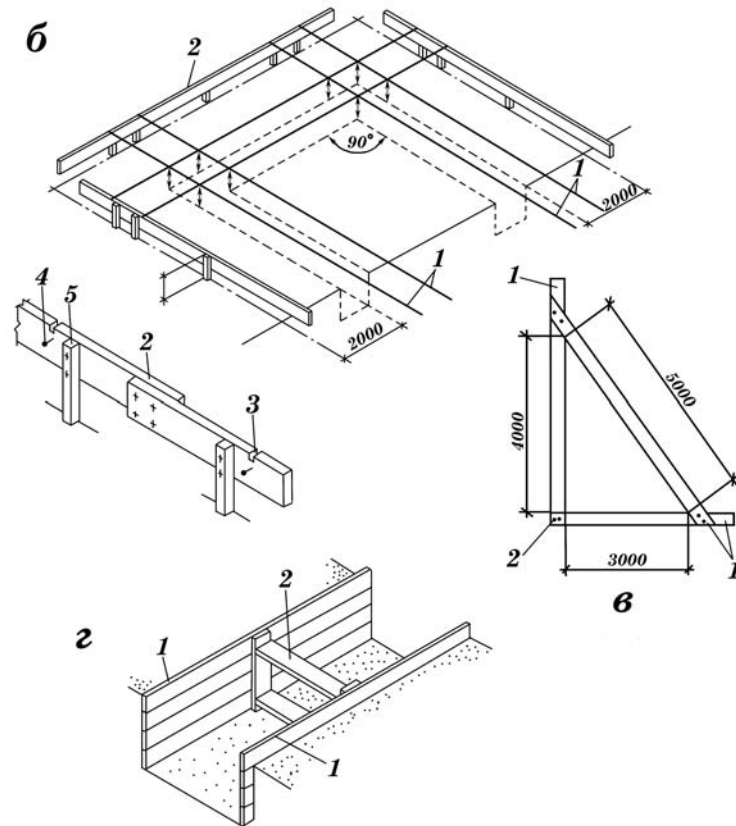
Подготовка площадки к строительству фундамента: б – устройство и конструкция деревянной обноски для разбивки осей дома: 1 – разбивочные контуры фундаментов из натянутой проволоки или лески (струны); 2 – деревянная обноска из досок размером 50х250 мм; 3 – пропилы в доске для фиксации струны; 4 – гвозди для крепления струны; 5 – деревянные или металлические столбики; в – треугольник для разметки прямых углов: 1 – доски размером 22х94 мм; 2 – гвозди по два в каждом углу; г – крепления стенок траншей: 1 – щиты из горбыля; 2 – распорка.
